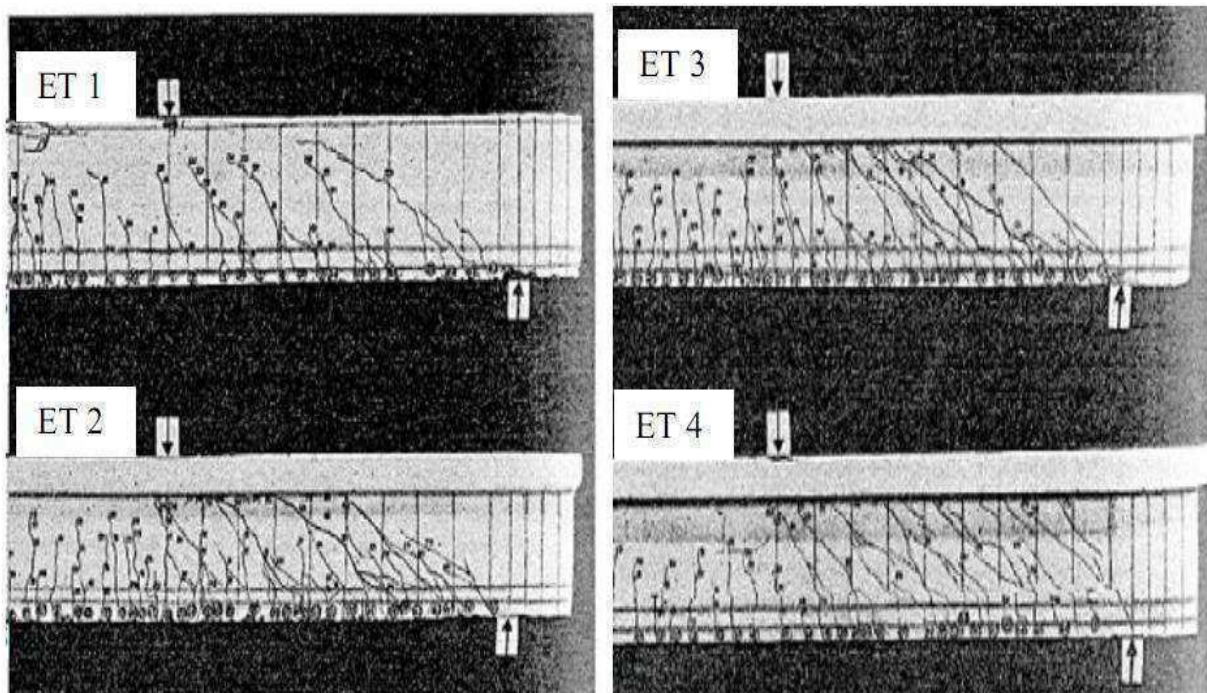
Mode de fissuration des différentes poutres [101].
